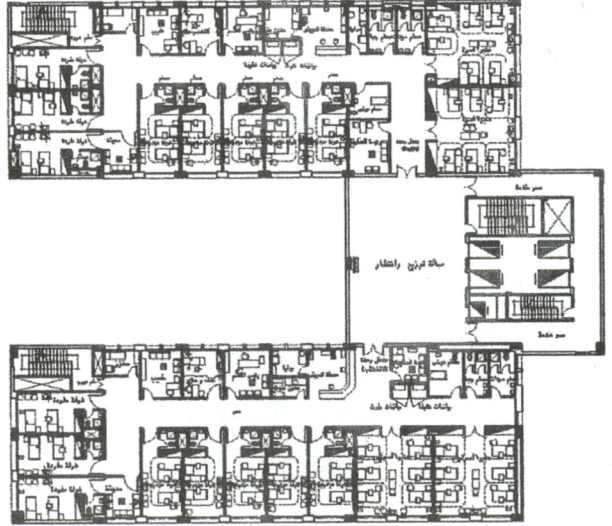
مسقط أفقي لغرفة مفردة في
